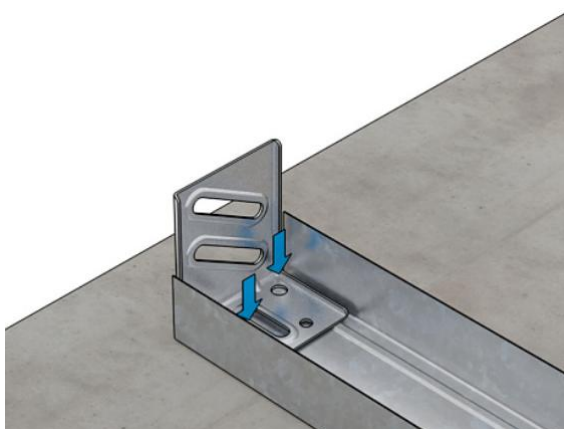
Крепление нижних уголков для профилей дверного проема
